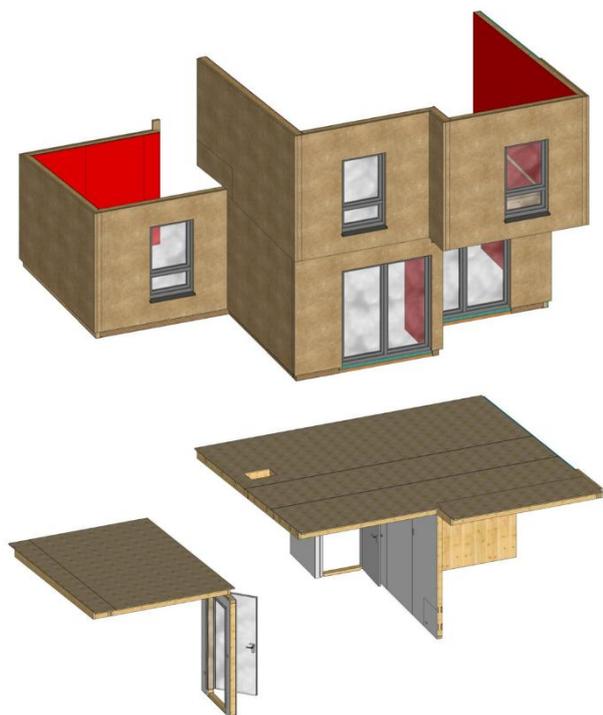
3D-Konstruktion Elemente. Quelle: IETC GmbH
